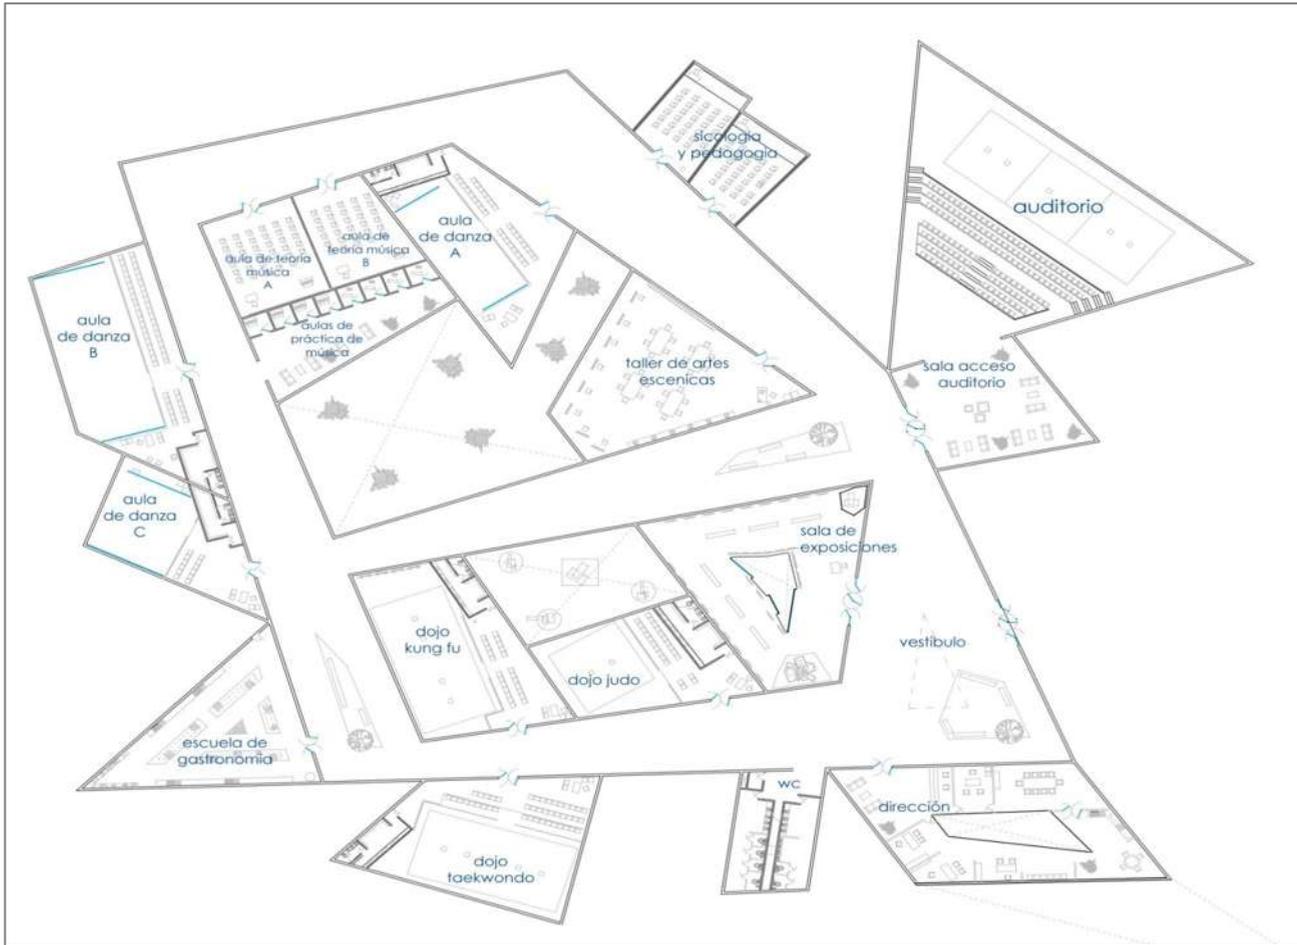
Planta, alzados o fachadas y perspectivas de la propuesta.
